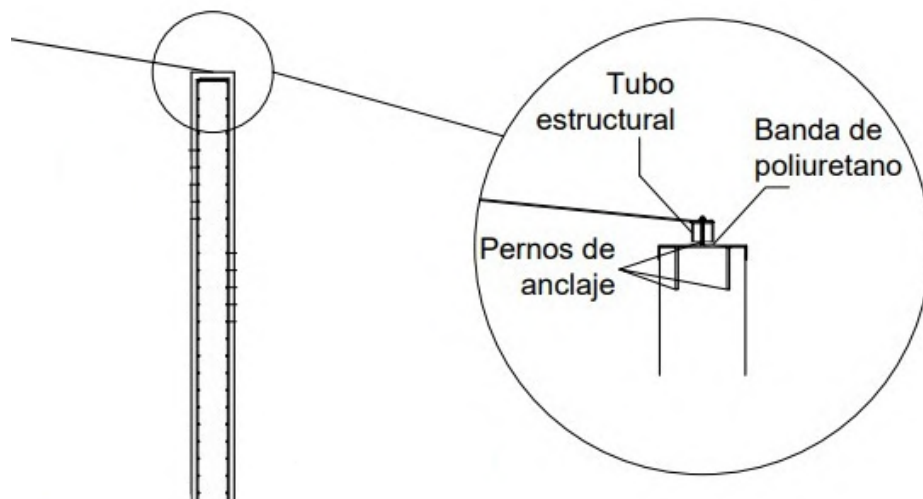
Esquema estructural de la cubierta metálica del biodigestor. Fuente: elaboración propia.
